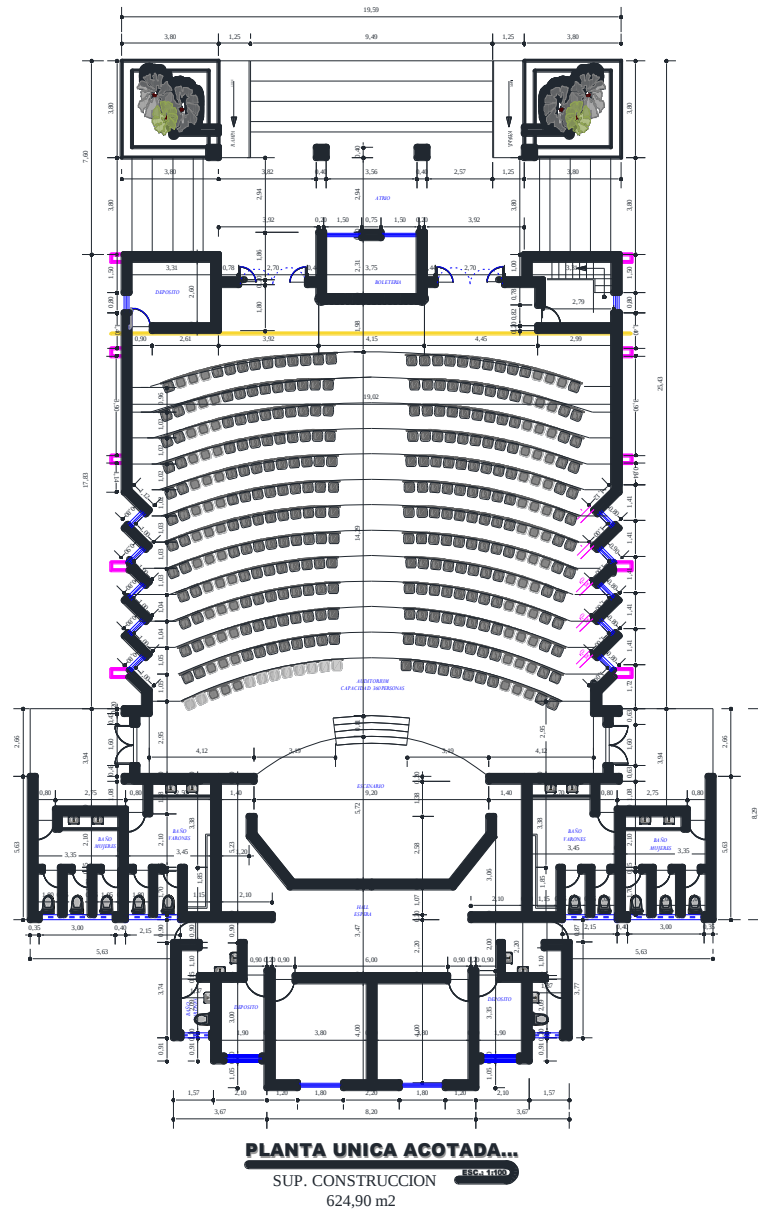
Plano en planta del auditorio, Elaboración Propia
